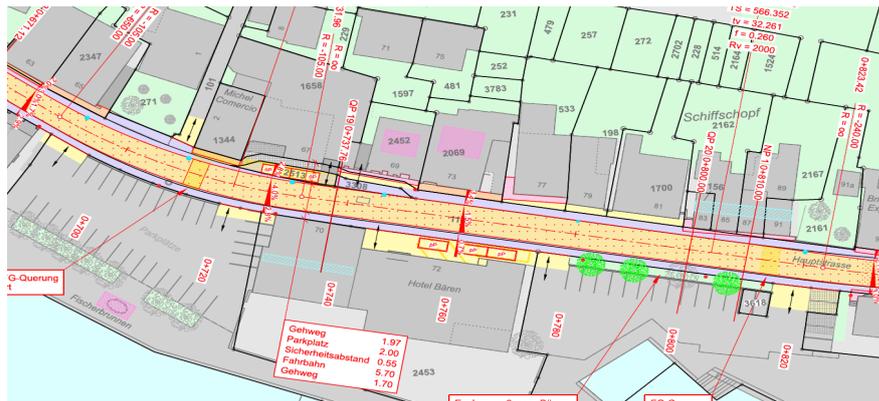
Ausschnitt Strassenbauprojekt Ortsdurchfahrt Brienz, Stand 07.09.2022
